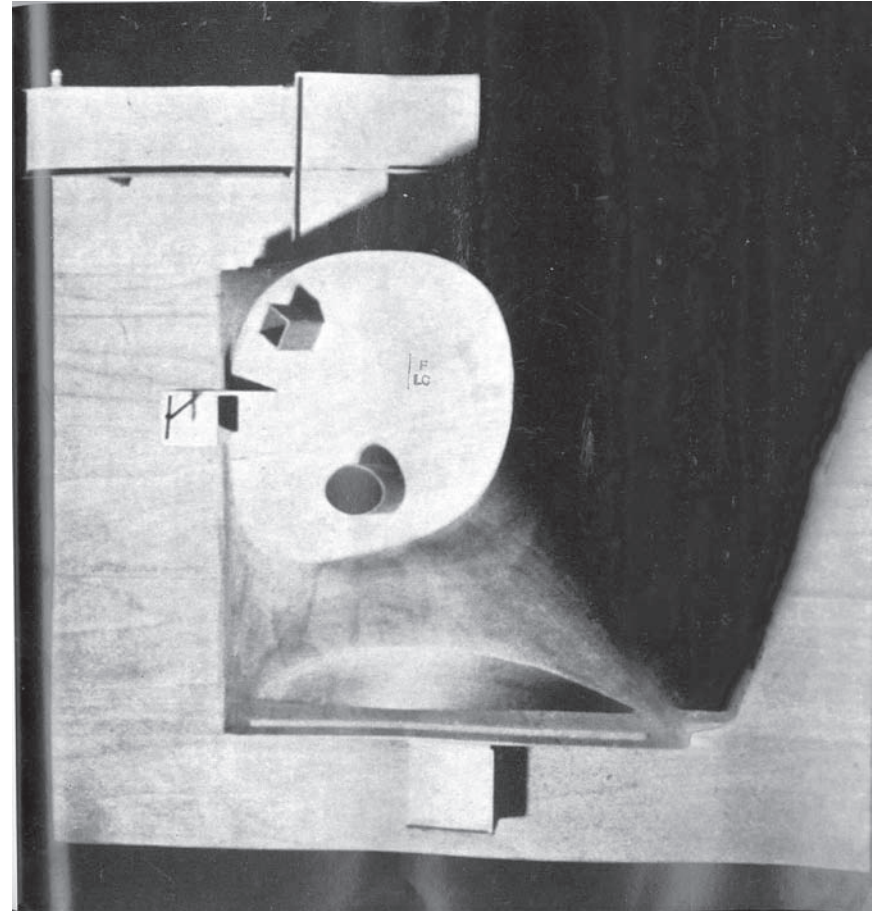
Alzado con campanario primer proyecto. FLC 32265. Septiembre 1961. Dib: José Oubrerie.
